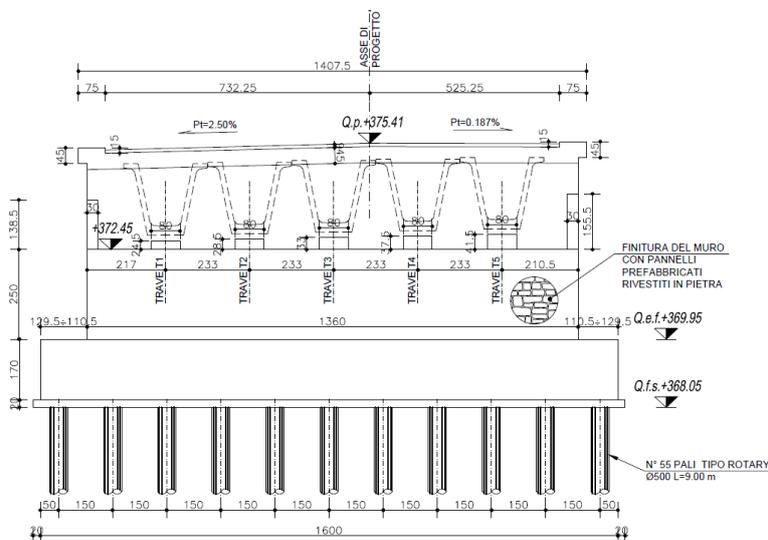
VISTA FRONTALE SPALLA SP1 VIADOTTO CASAL DEL MONTE
